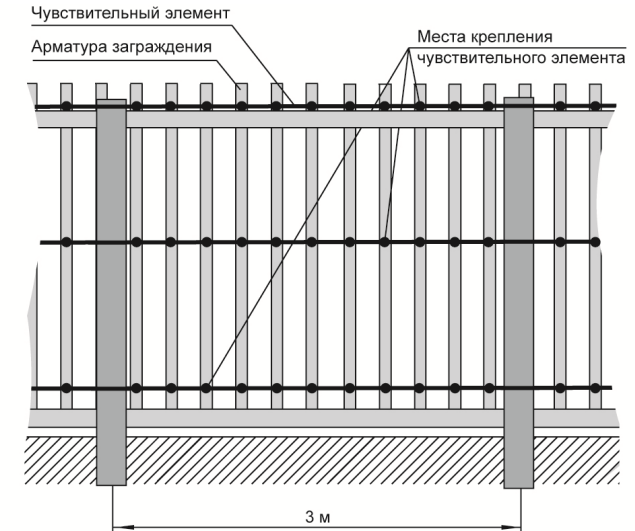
Заграждение из сварных (кованых) решёток
